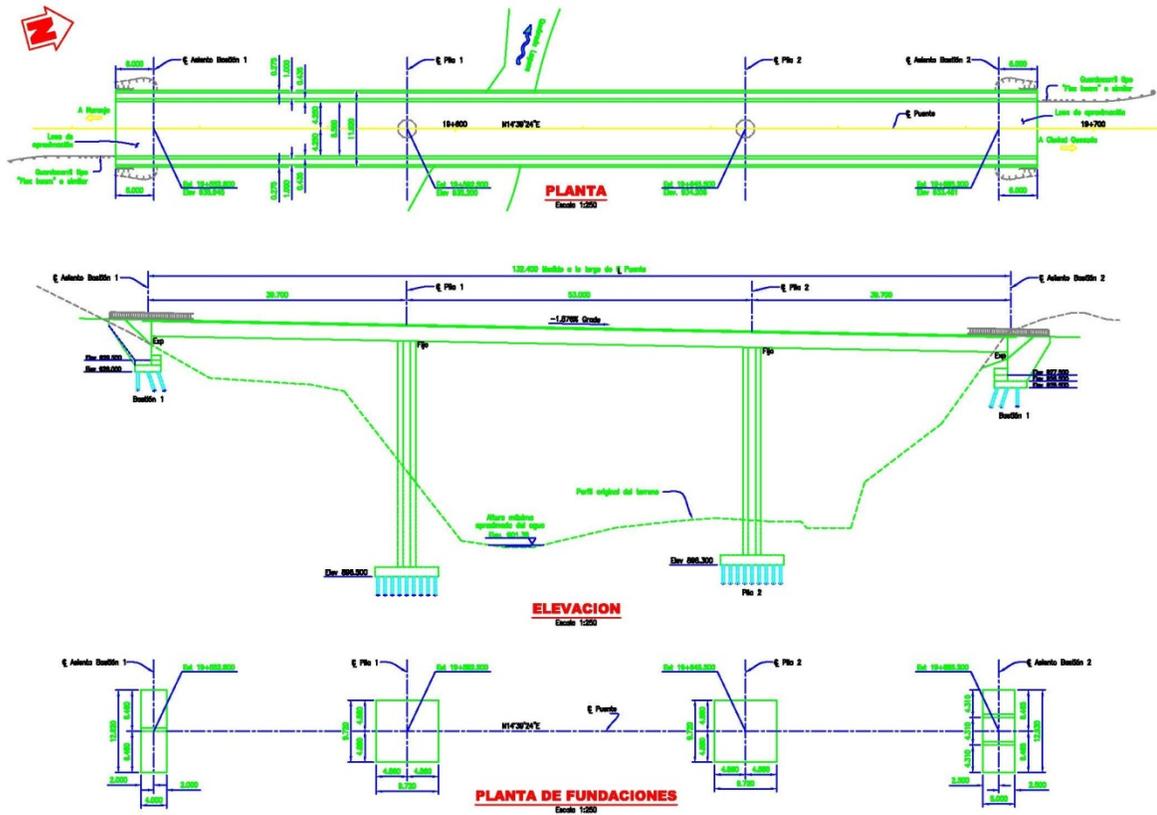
Plano sobre el puente sobre la Quebrada Laguna donde se identifican sus elementos.
